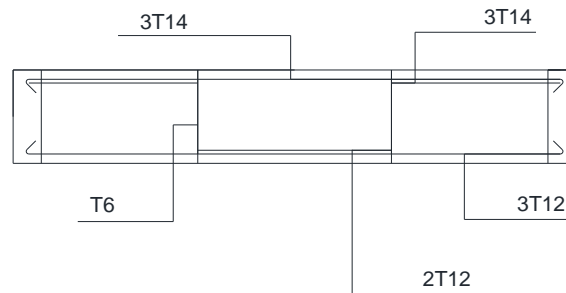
Coupe longitudinale d'une poutre principale 25x35cm (bâtiment R+7)
